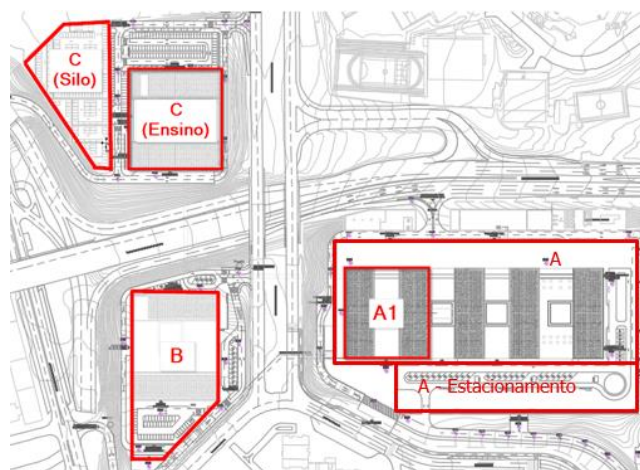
Planta do Projeto do Hospital (ARSLVT, 2026)
